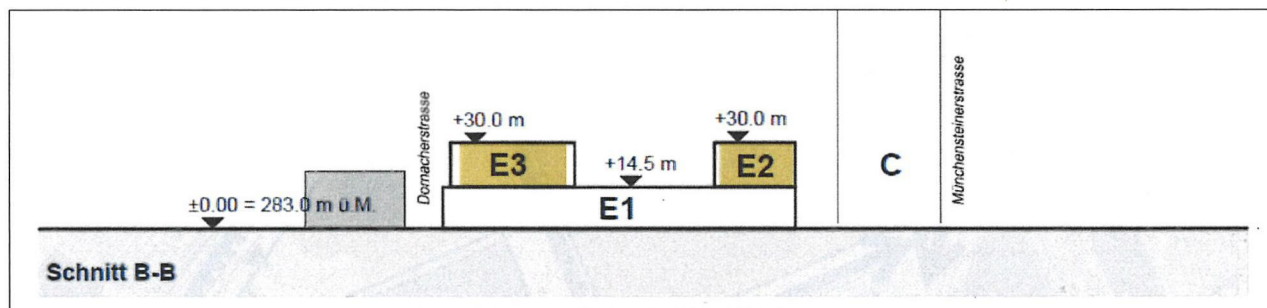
Entwurf Bebauungsplan Schnitt B-B. Dargestellt sind die Baufelder E1-E3 und das Baufeld C.
